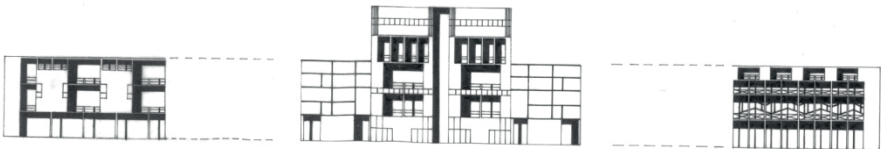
Prospetti su strada e sulla corte e sezione A-A con prospetto edificio servizi.
